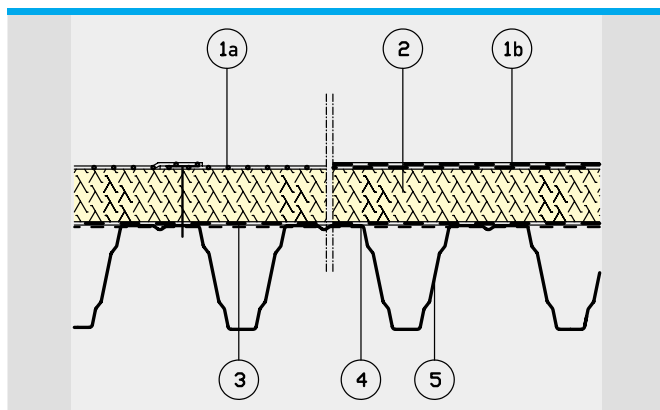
1 Einlagige (a) / Zweilagige Dachabdichtung (b);
